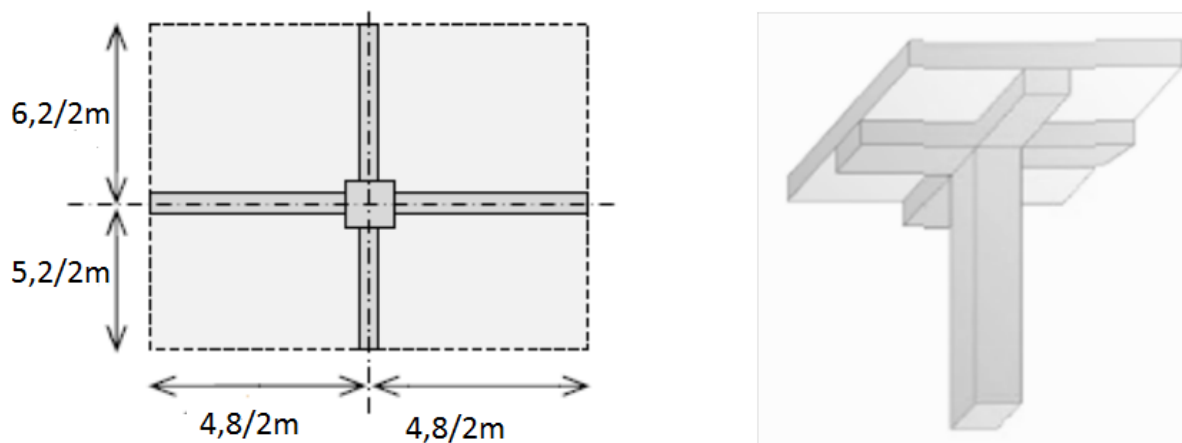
La surface du plancher revenant au poteau (Poteau central).
